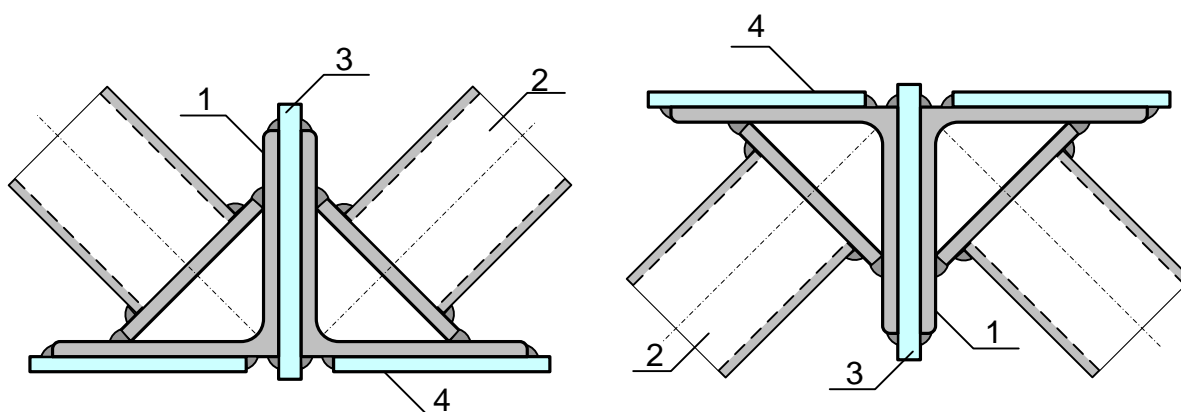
Вузол з'єднання елементів нижнього і верхнього поясів: 1 – кутики поясу; 2 – розкоси ферми; 3 – вертикальна фасонка; 4 – горизонтальні фасонки
